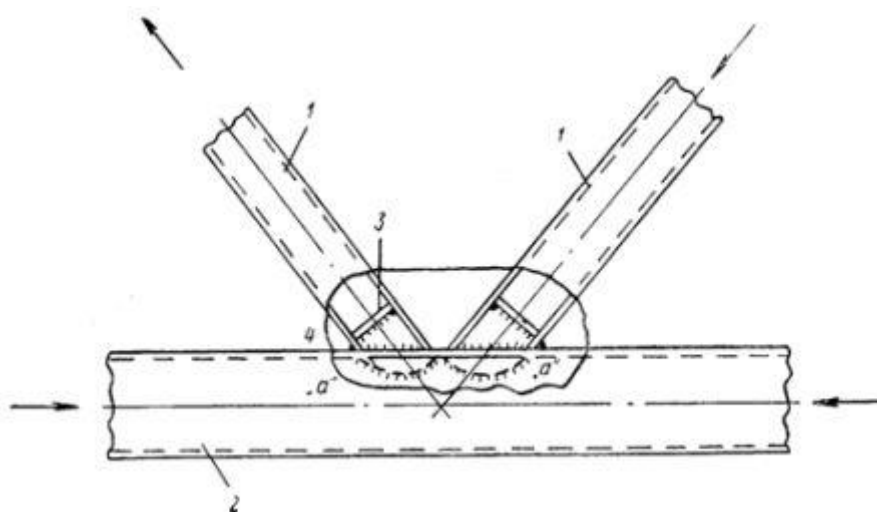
Схема узла крепления раскосов к поясу трубчатой бесфасоночной фермы: 1 – элементы раскосной решетки; 2 – пояс; 3 – диафрагмы; 4 – пяточная зона примыкания элементов раскосной решетки к поясу; «а» – участки стенки пояса.
